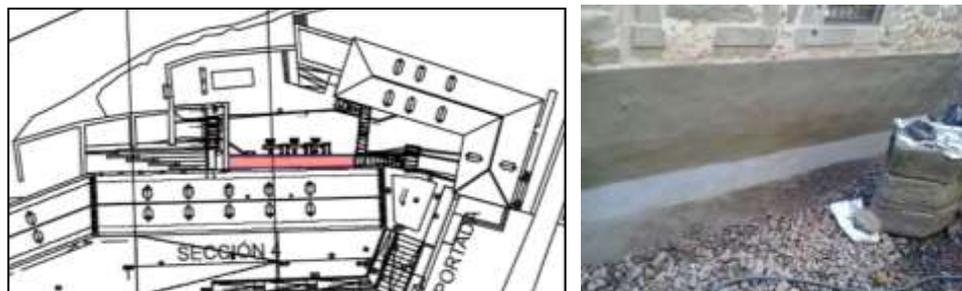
Planta de ubicación del canal a impermeabilizar y detalle del canal.
